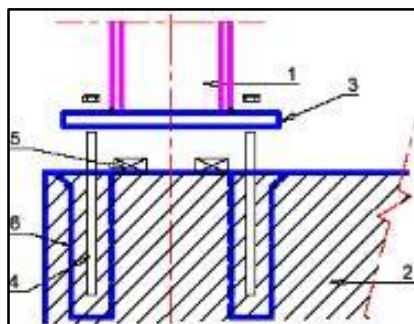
système de liaison Poteau/ Fondation Source : (Semahi, 2008 :81)
